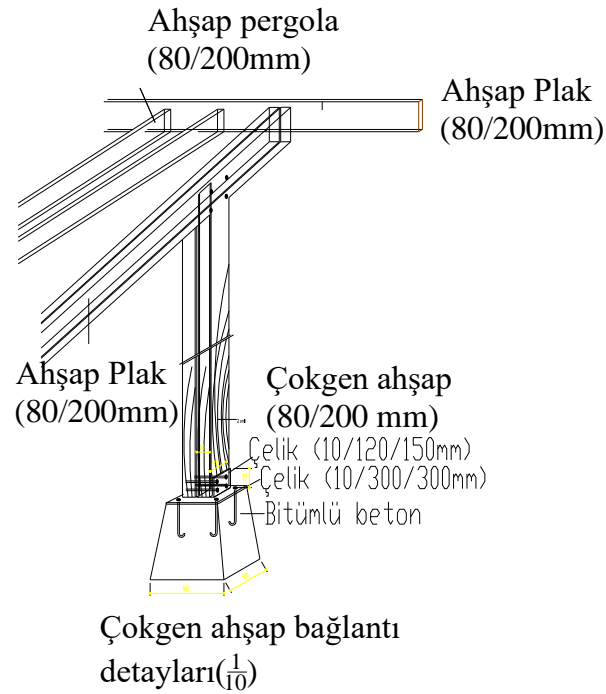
Beton ayaklı pergola plan ve kesiti
